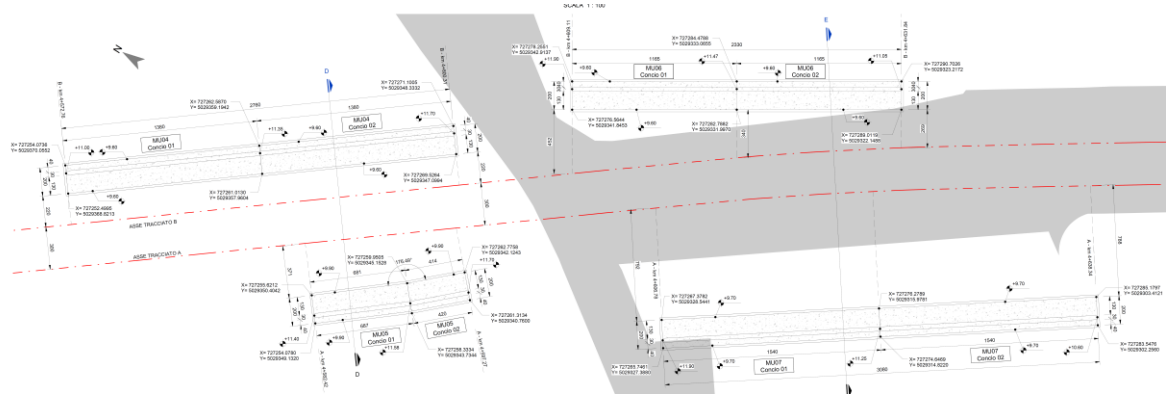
Planimetria muri di sostegno MU04-05-06-07
